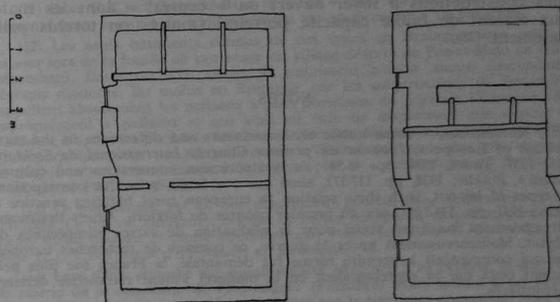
Les deux plans de base des maisons irlandaises : a) à foyer « central » ; b) à foyer adossé. On notera que la cheminée du plan b n'est que très partiellement dépendante du pignon (plans schématiques d'après un relevé d'Alan CAMPBELL et d'Alan GAILEY).
